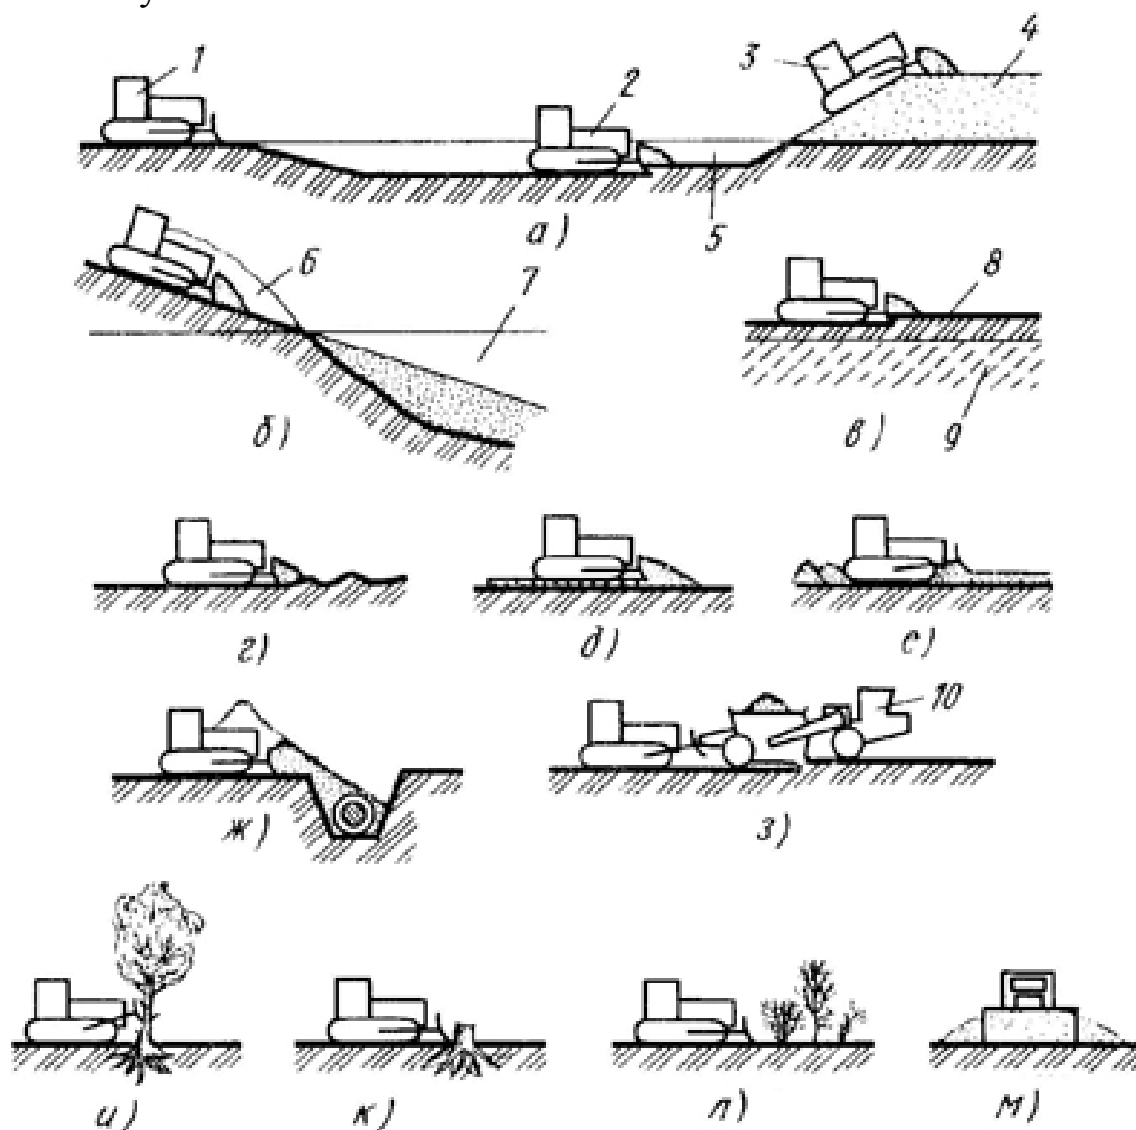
Основные виды работ, выполняемые бульдозерами: *а* – разработка котлованов, траншей, каналов с отсыпкой грунта в кавальеры, насыпи; *б* – срезка косогоров и засыпка выемок; *в* – снятие плодородного слоя; *г* – планировка передним ходом; *д* – разравнивание грунта; *е* – планировка при заднем ходе; *ж* – засыпка траншей; *з* – толкание скрепера при наполнении ковша грунтом; *и* – валка деревьев; *к* – корчевка пней; *л* – срезка кустарников и мелкоколесья; *м* – снегоочистительные работы; *1* – исходное положение бульдозера; *2* – резание и транспортирование грунта; *3* – бульдозер на насыпи; *4* – насыпь или кавальер; *5* – траншея; *6* – косогор; *7* – выемка; *8* – плодородный слой; *9* – основной грунт; *10* – скрепер
